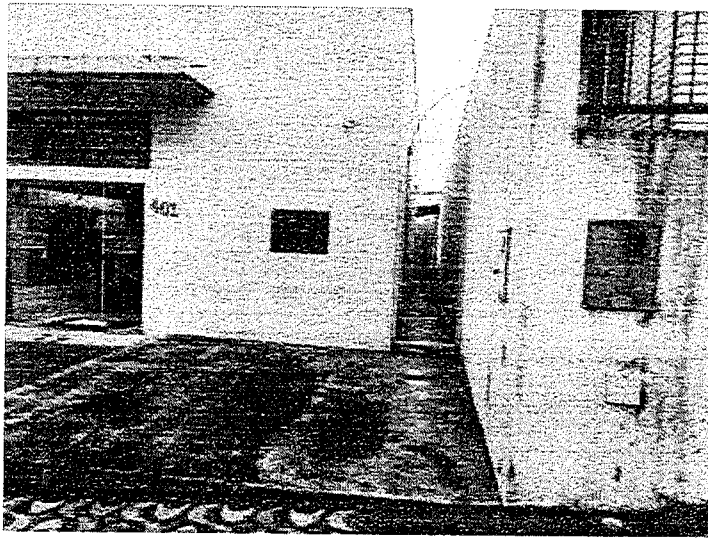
FACHADA DA FARMACIA EXISTENTE
